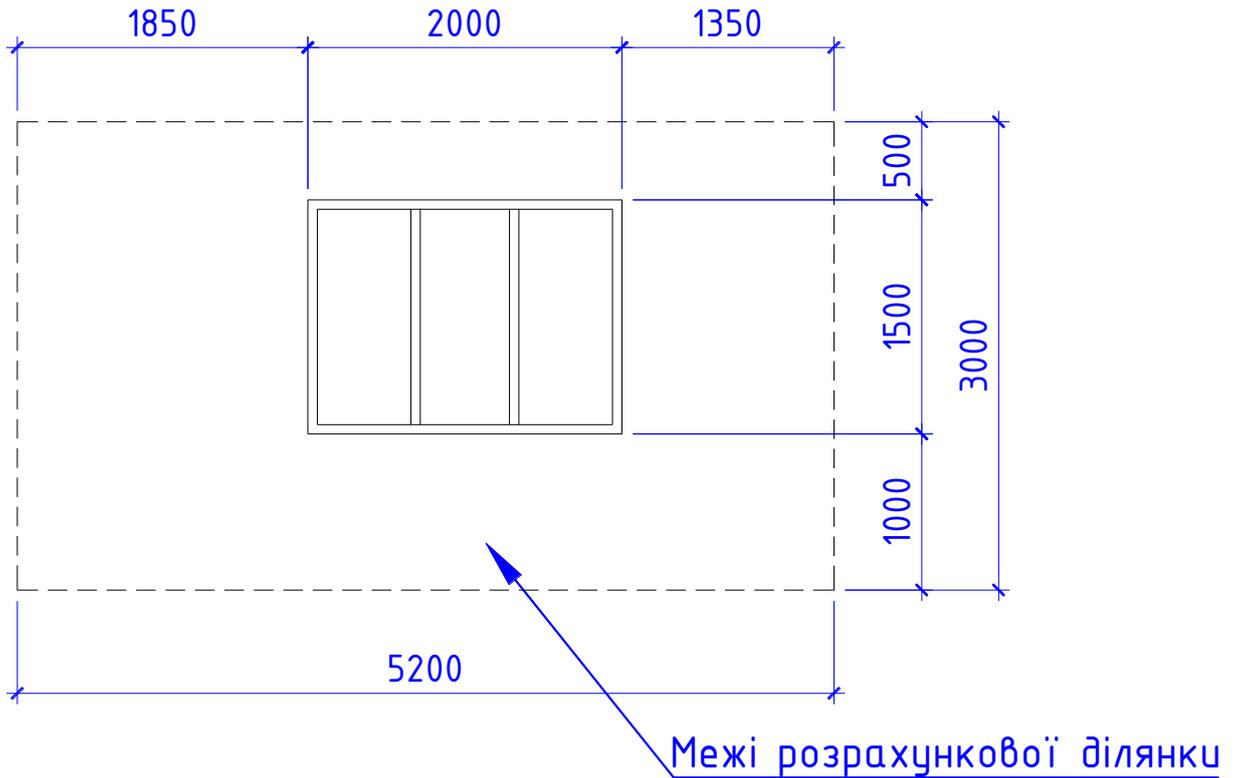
Фрагмент фасаду з розрахунковою ділянкою
